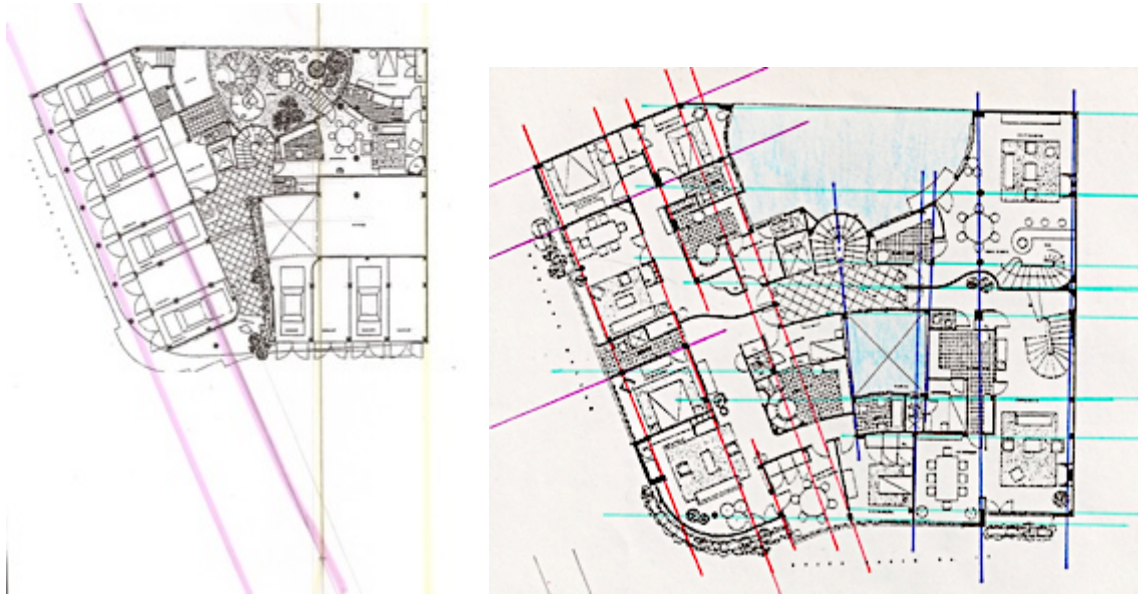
Planta arquitectónica, planta baja acceso principal por la calle de Rubén Darío y acceso a estacionamientos por la calle de Enrique Wallon.
